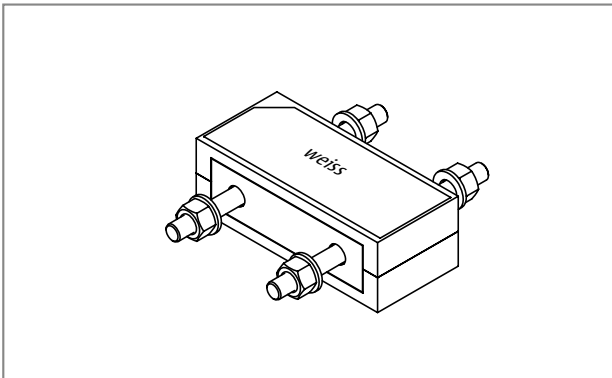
Schöck Isokorb® T Typ S-N-D16: Isometrie; Kennfarbe T Typ S-N: weiss
